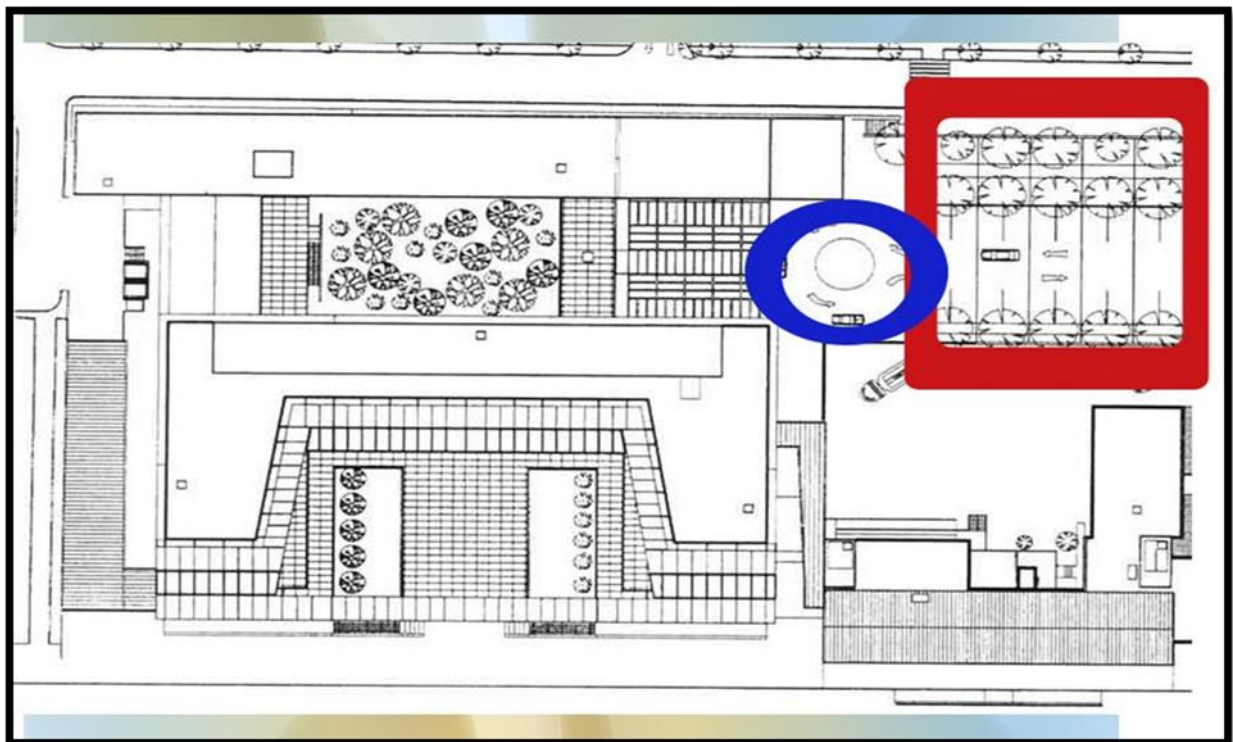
Aménagement extérieur. Source: Architectural Design - New HealthFacilities.
